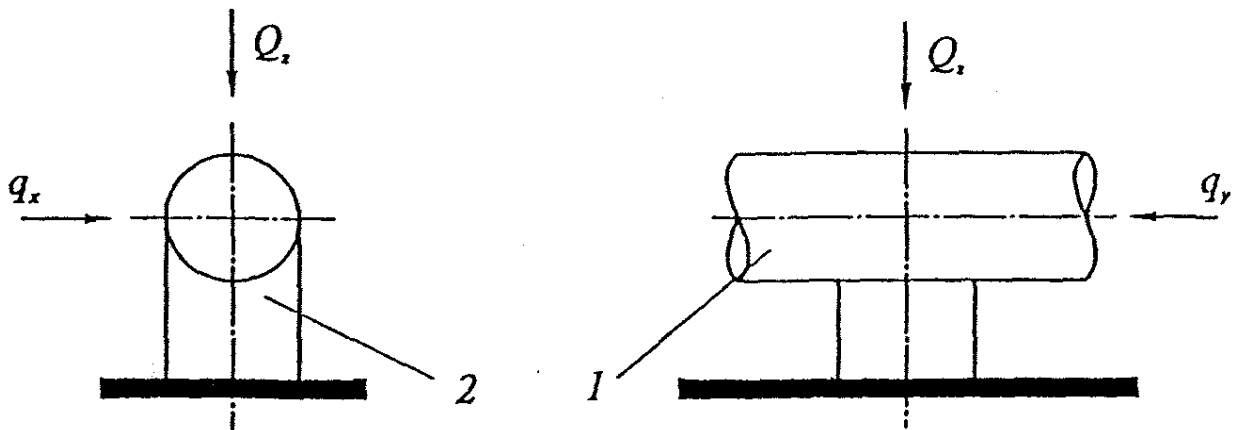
Схема нагрузок на опоры: 1 — труба; 2 — подвижная опора
